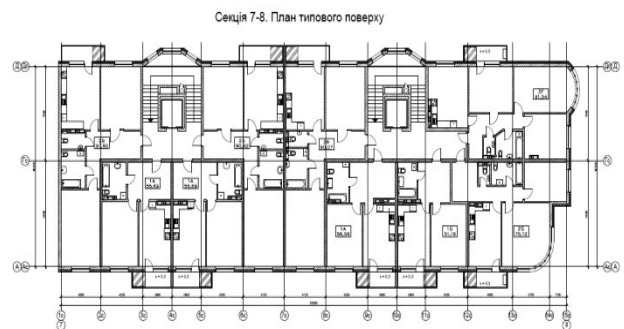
План типового поверху секції № 7 та № 8 житлового будинку /
